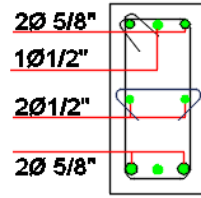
TIPOS DE VIGAS A UTILIZAR
